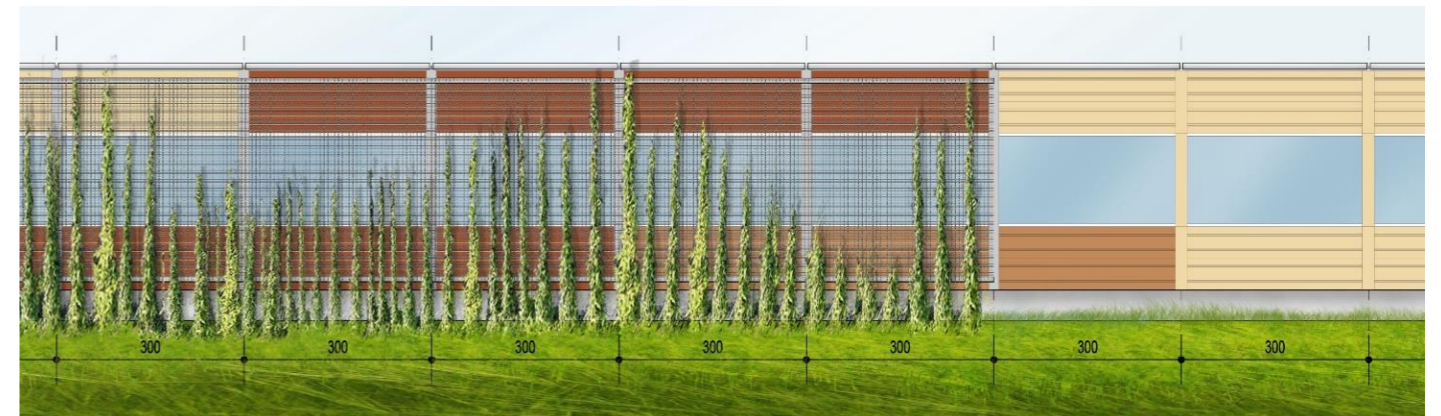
BARRIERA ACUSTICA MISTA FONOASSORBENTE-FONOISOLANTE SU RILEVATO – VISTA PROSPETTICA LATO RICETTORE
